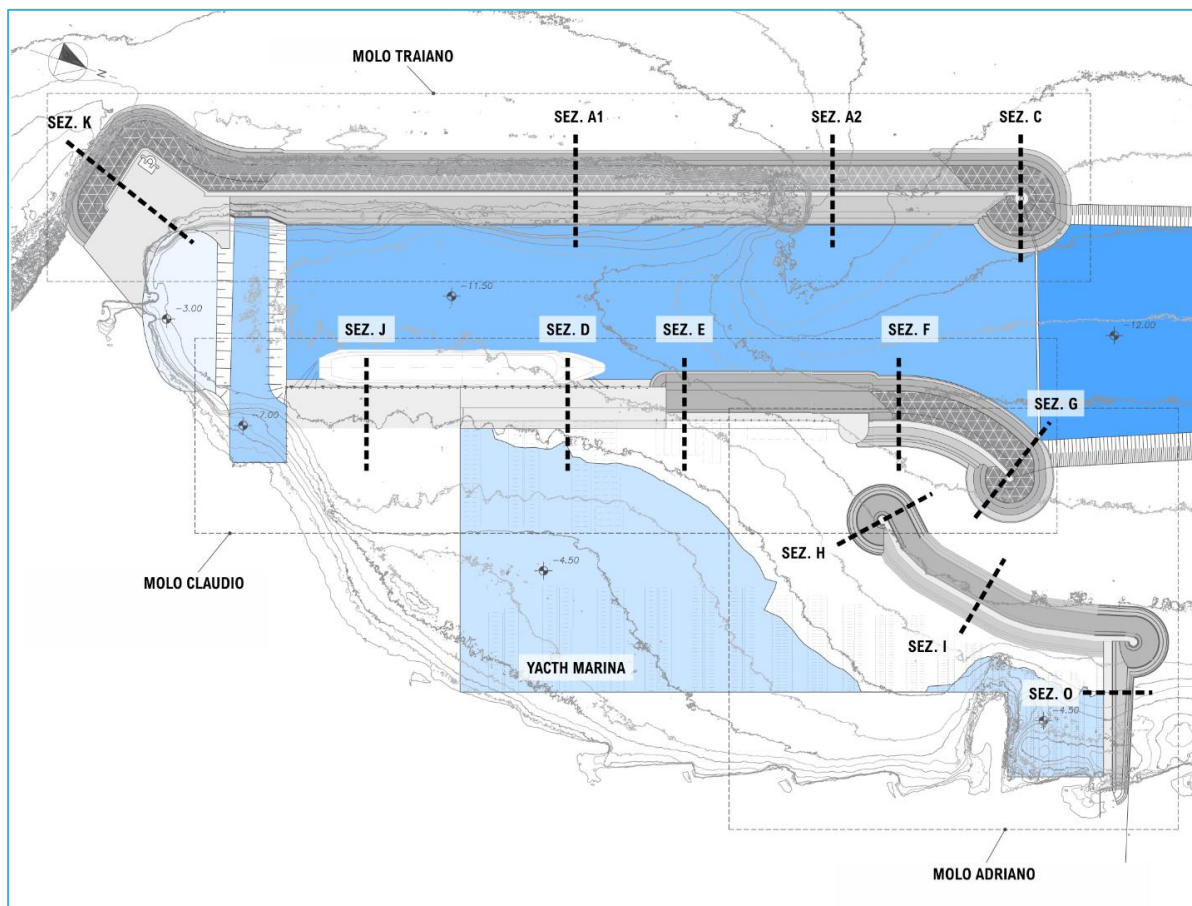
Planimetria di Progetto delle Opere Marittime
